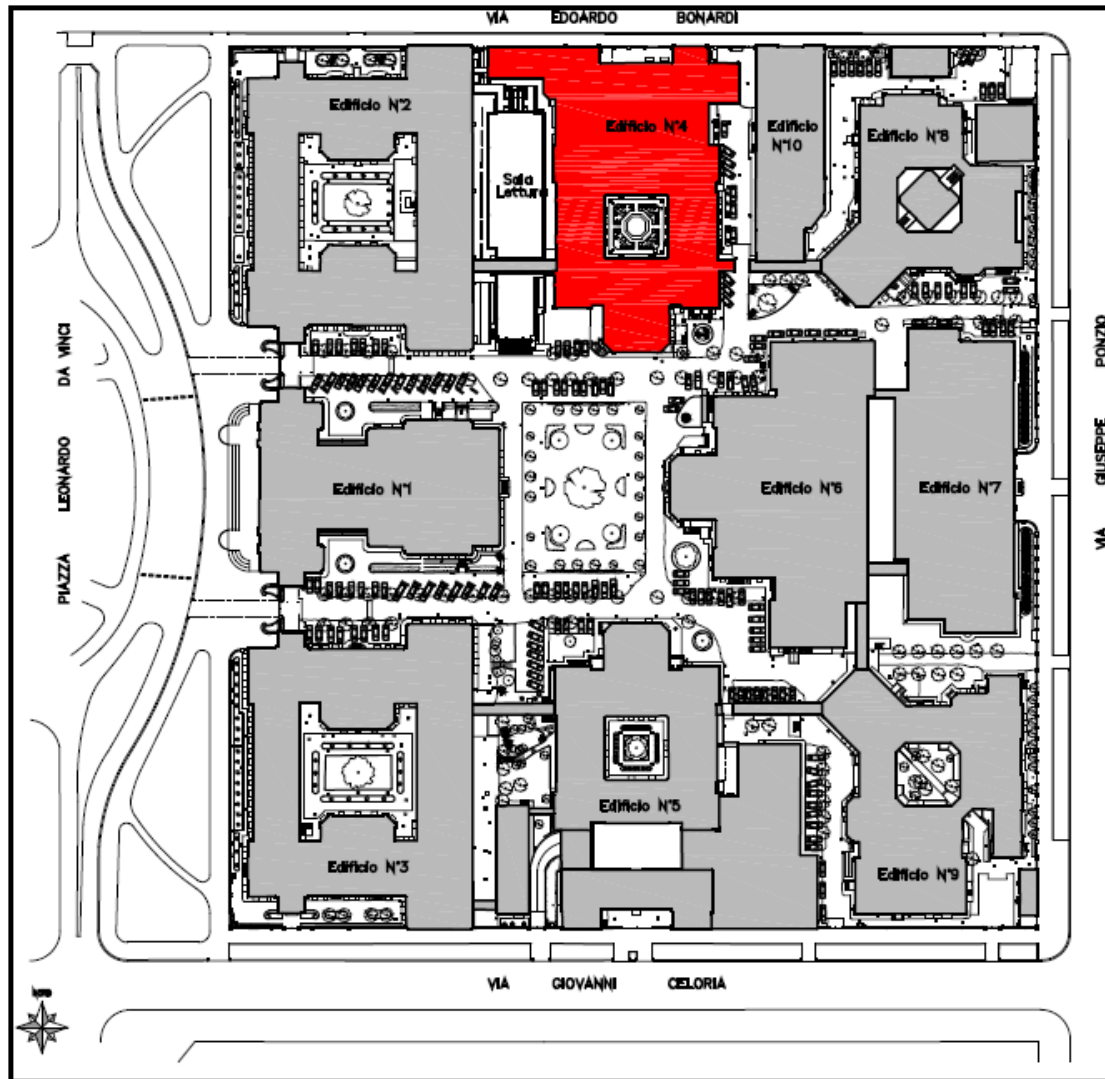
Planimetria Campus Leonardo (in rosso l'Edificio 4)
